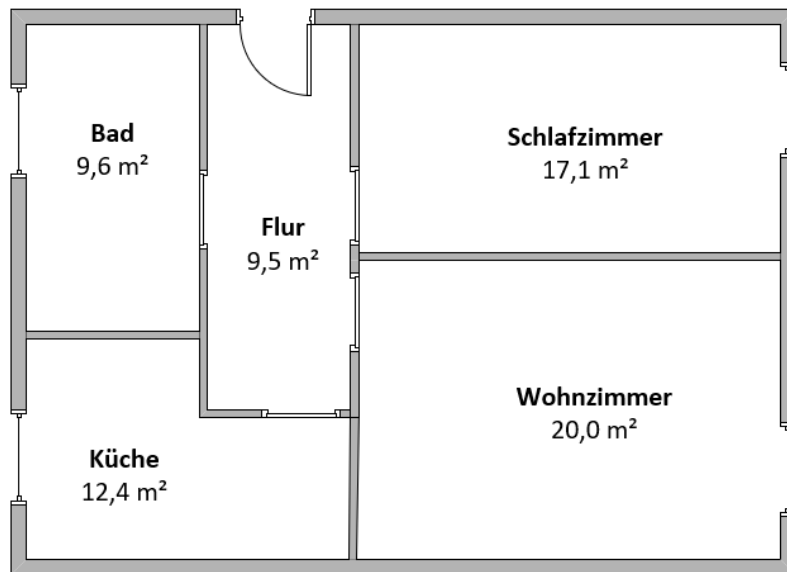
Grundriss Zwei-Zimmer-Wohnung (eigene Darstellung)
